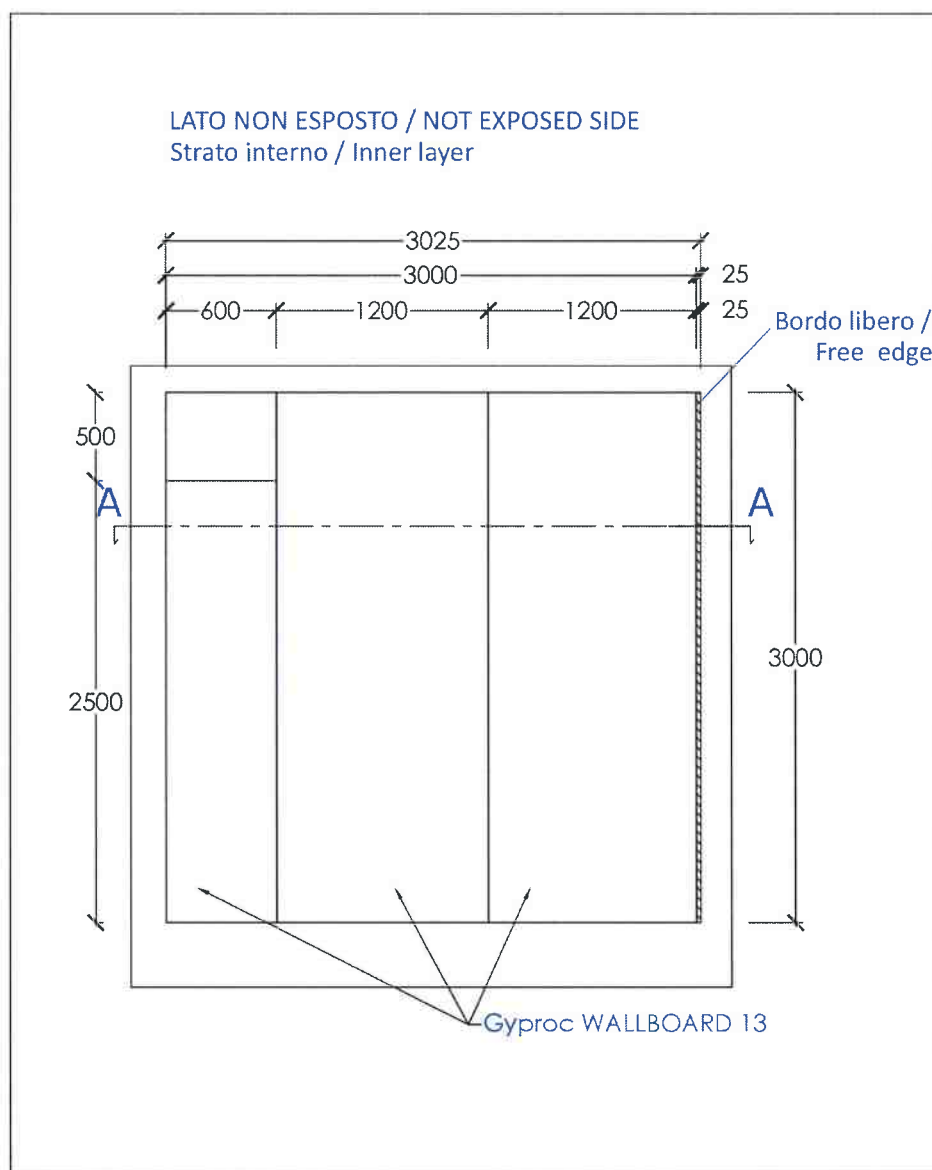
Lato non esposto – strato interno / Not exposed side – Inner layer
